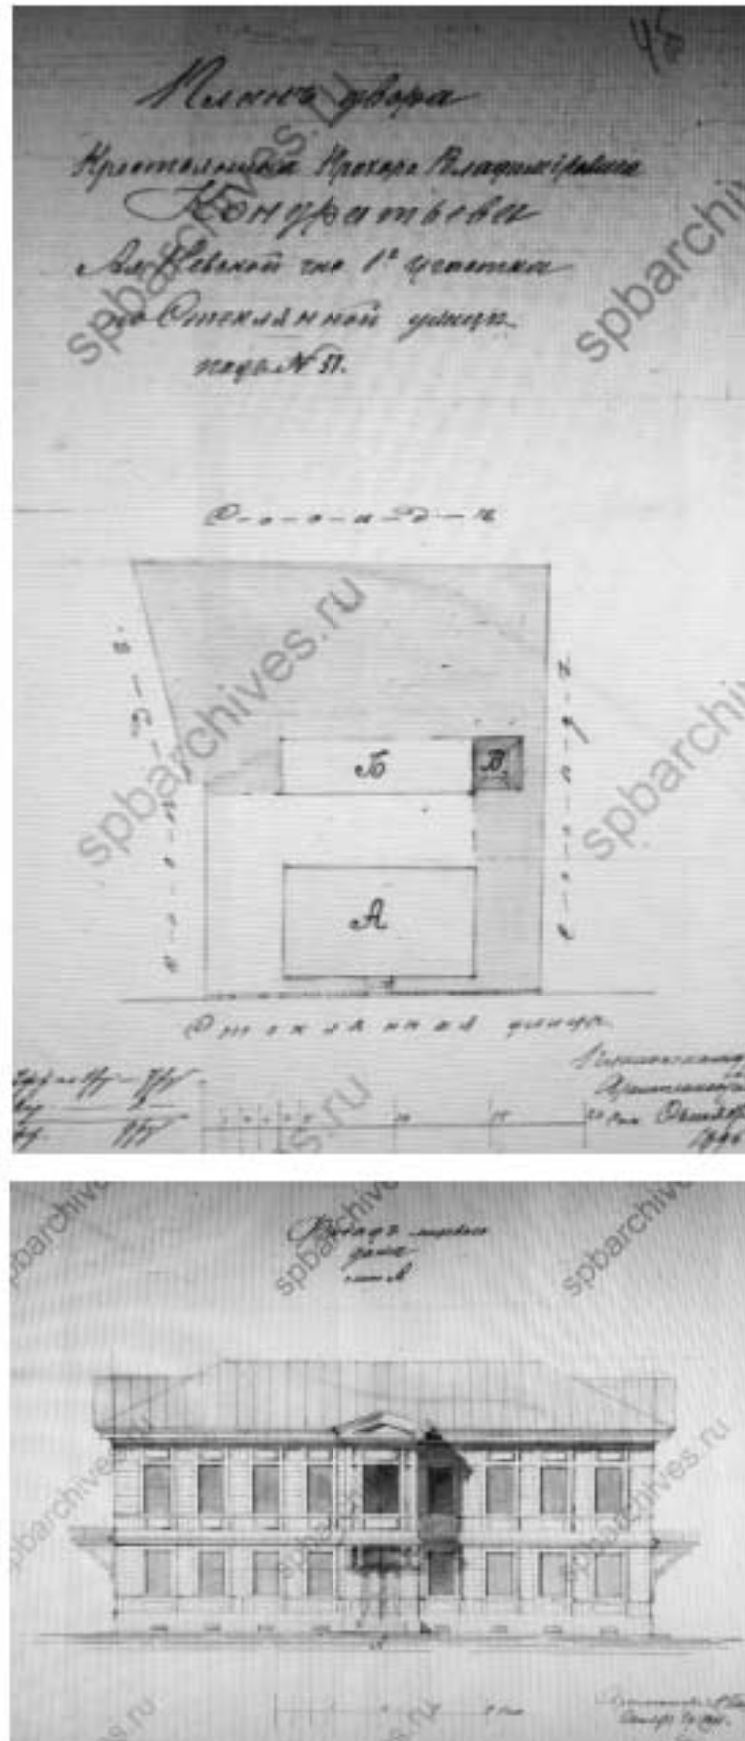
План участка, фасад здания по адресу Стеклойная ул., 51
